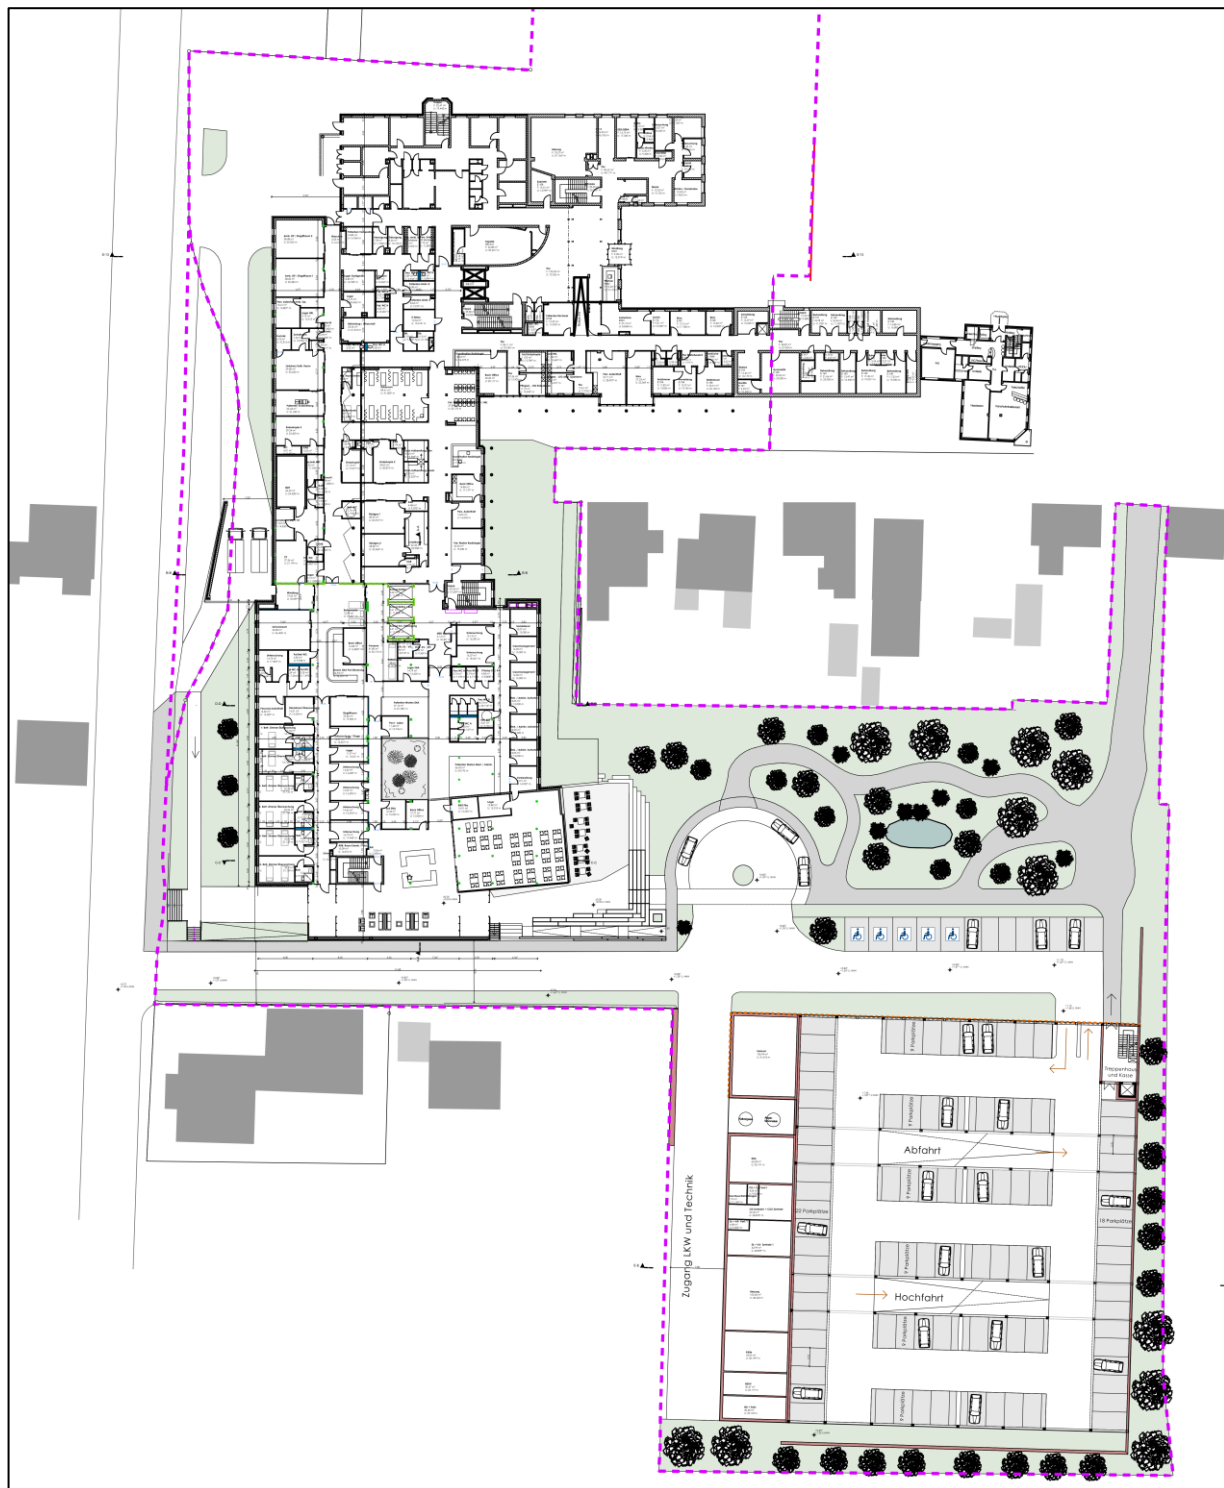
Übersichtslageplan mit dem geplanten Anbau (südlicher Gebäudeteil des Krankenhauses) sowie dem geplanten Parkhaus südöstlich, Quelle: /17/.
